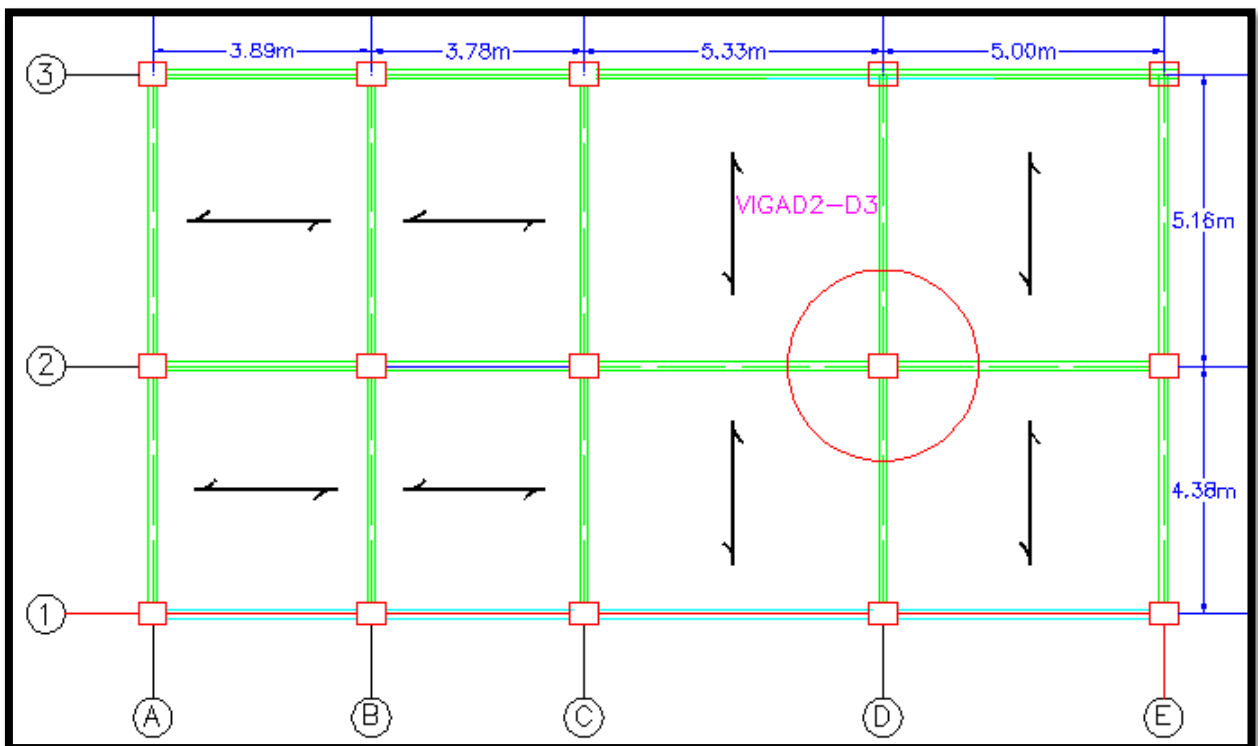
Vista en planta cuerpo 2, marcando la columna en análisis.
